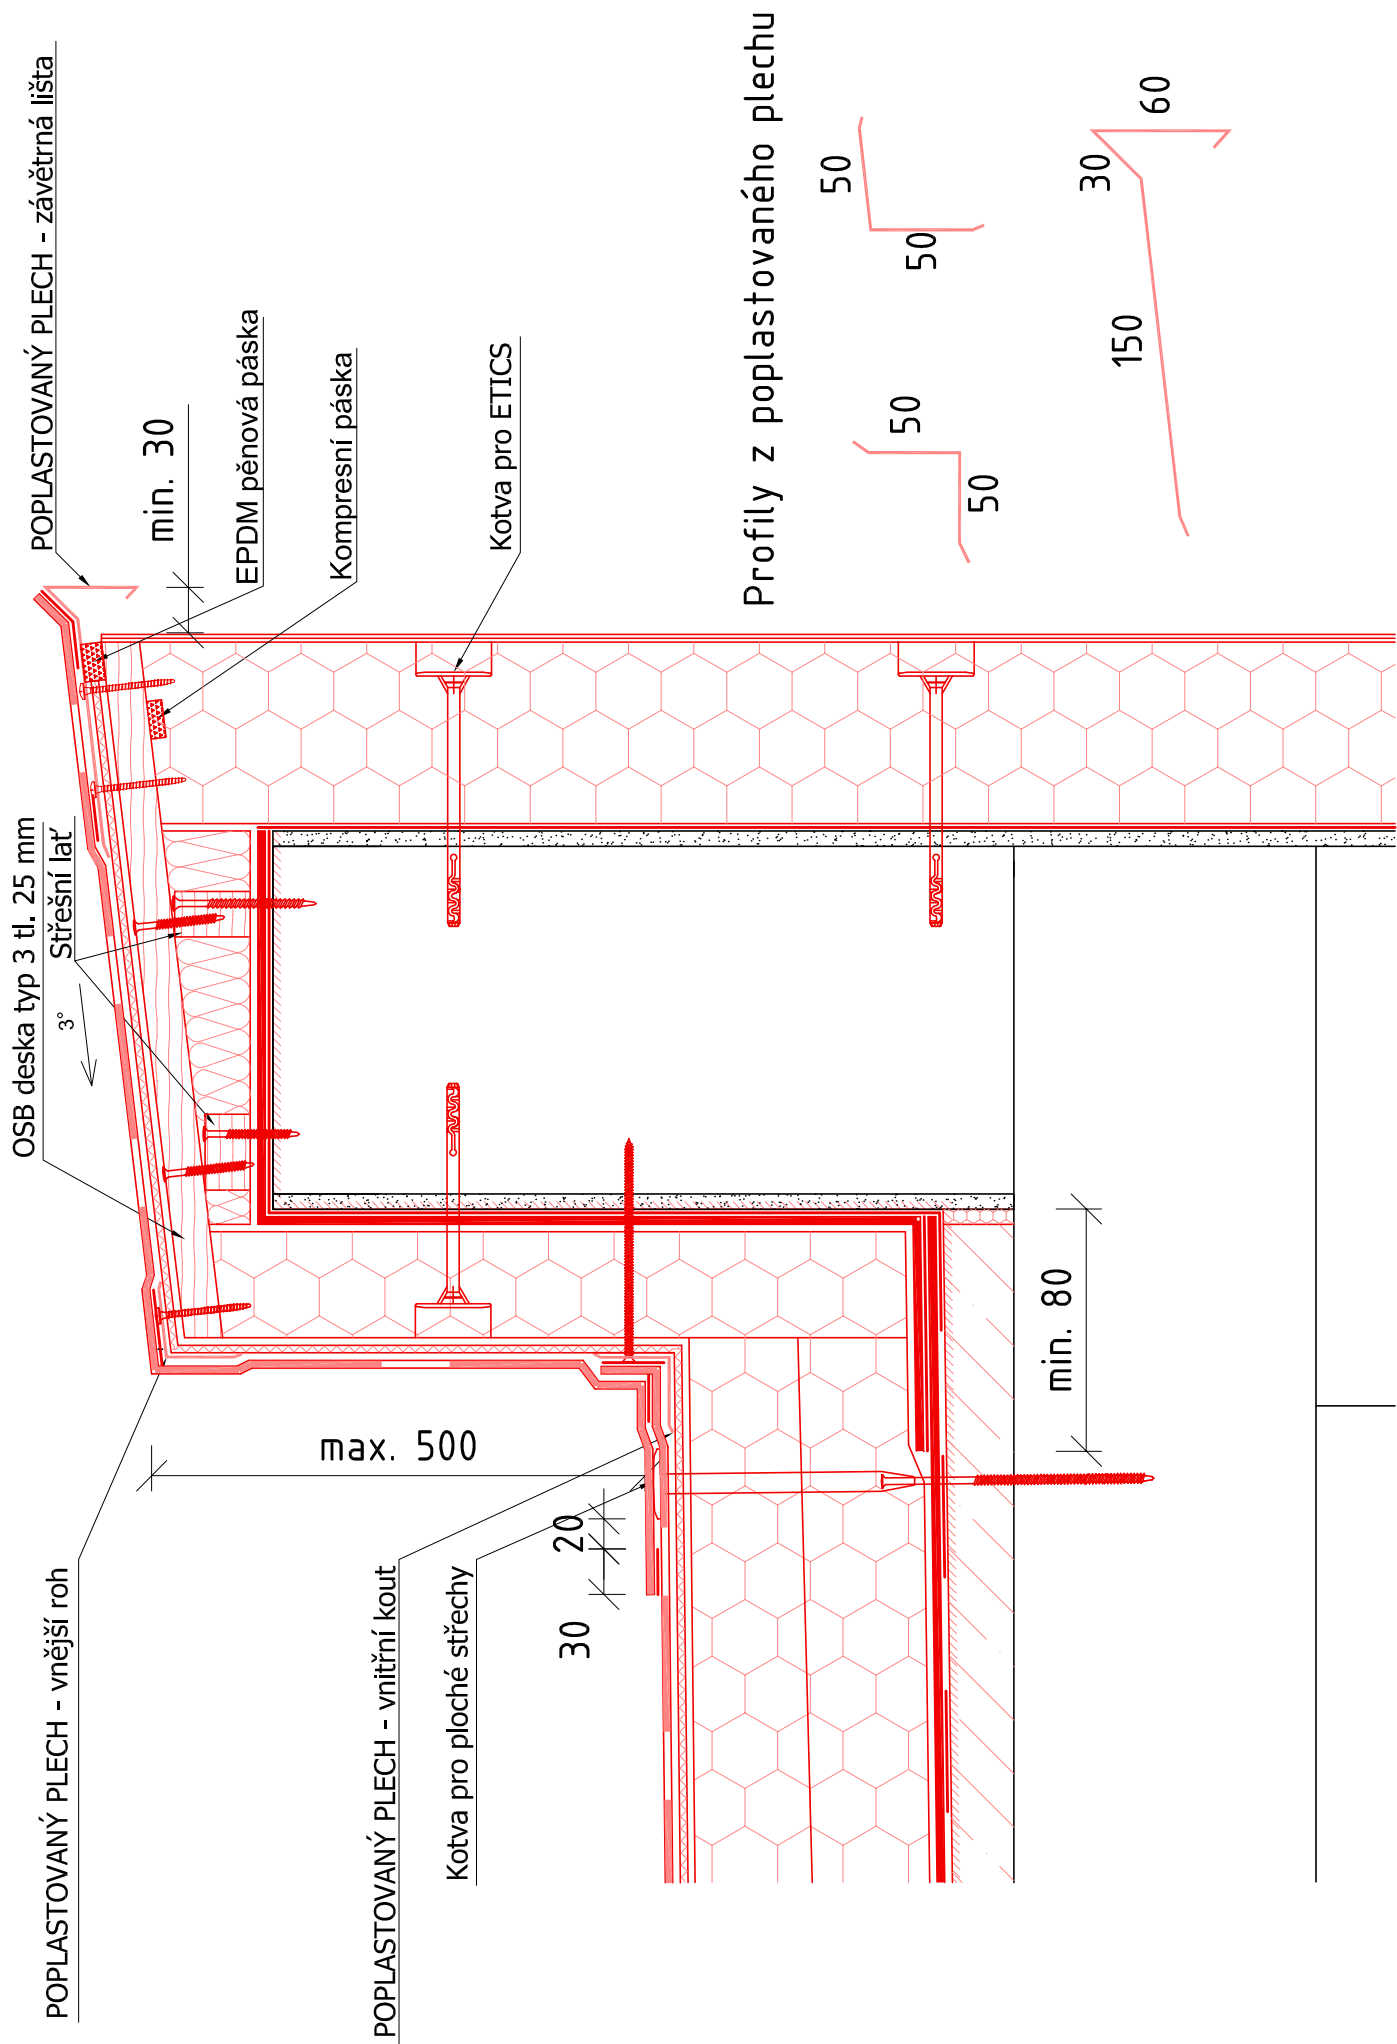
SKLADBA S/1b - UKONČENÍ U OKAPU / M 1:10
